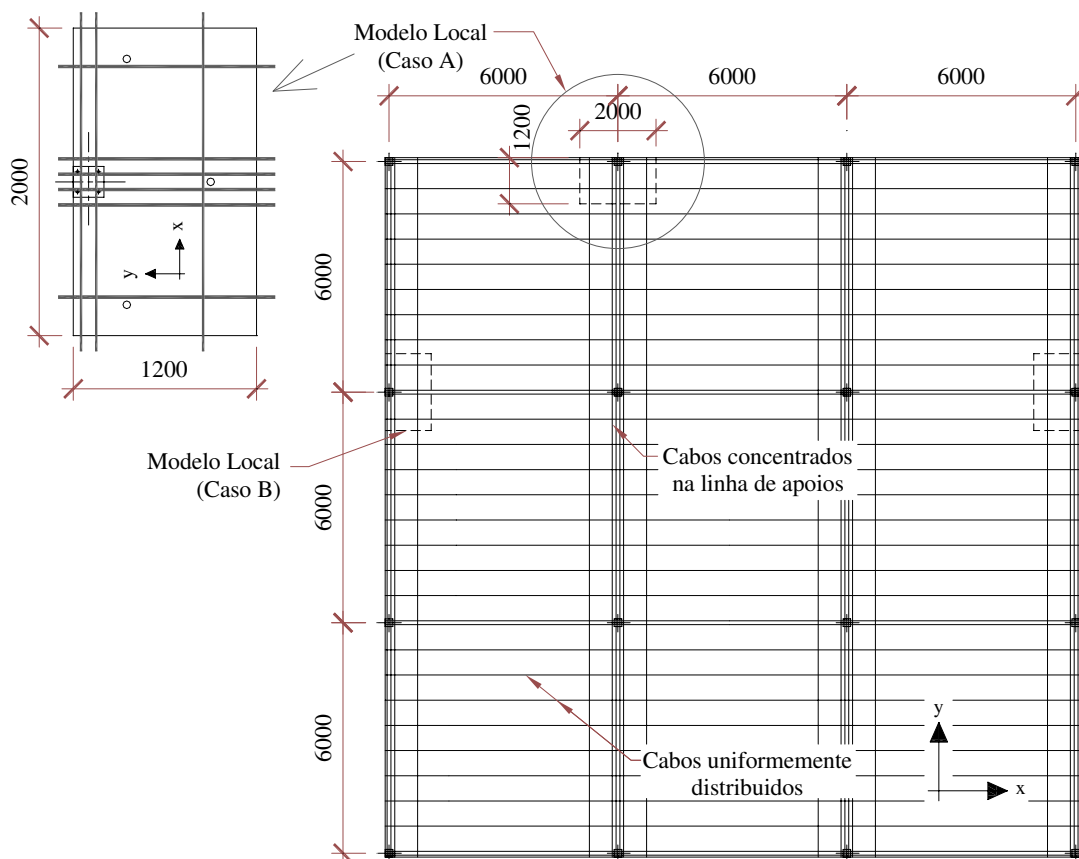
Arranjo dos cabos no pavimento de laje protendida
